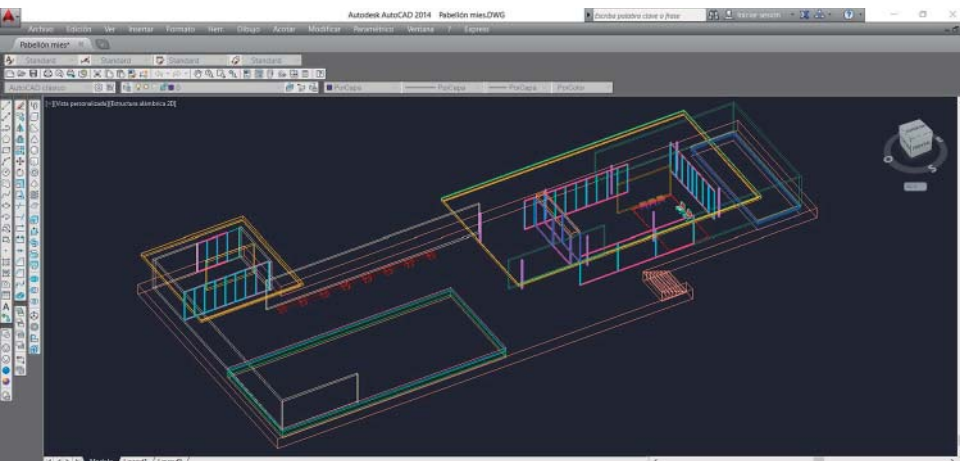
Modelo 3D levantado a partir de los planos originales de la reconstrucción del pabellón de 1983
